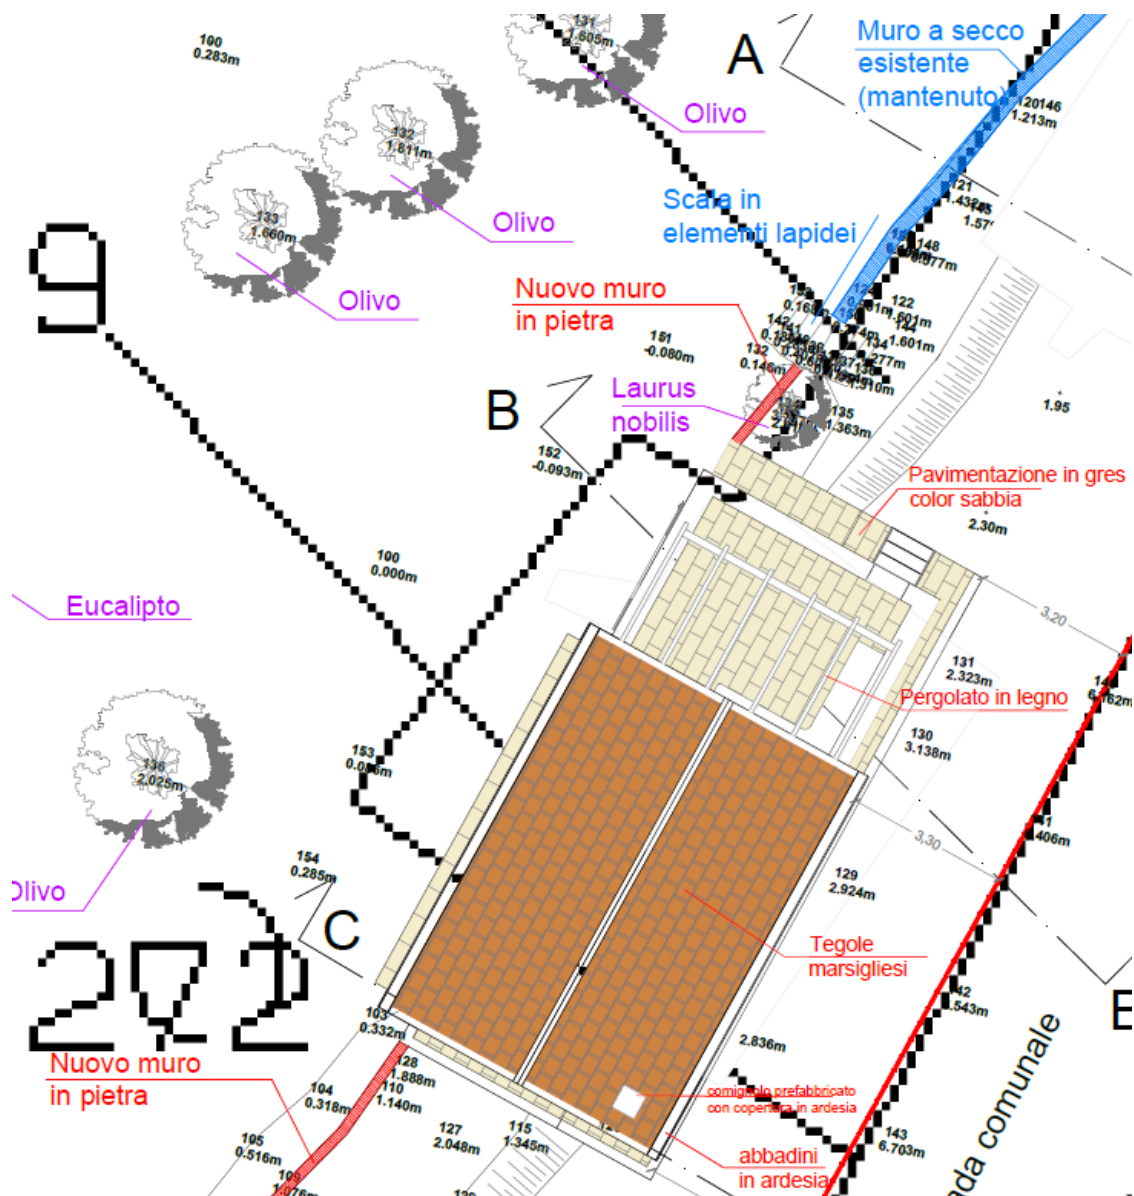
stralcio tavola 03 ProgeTec – planimetria progetto
